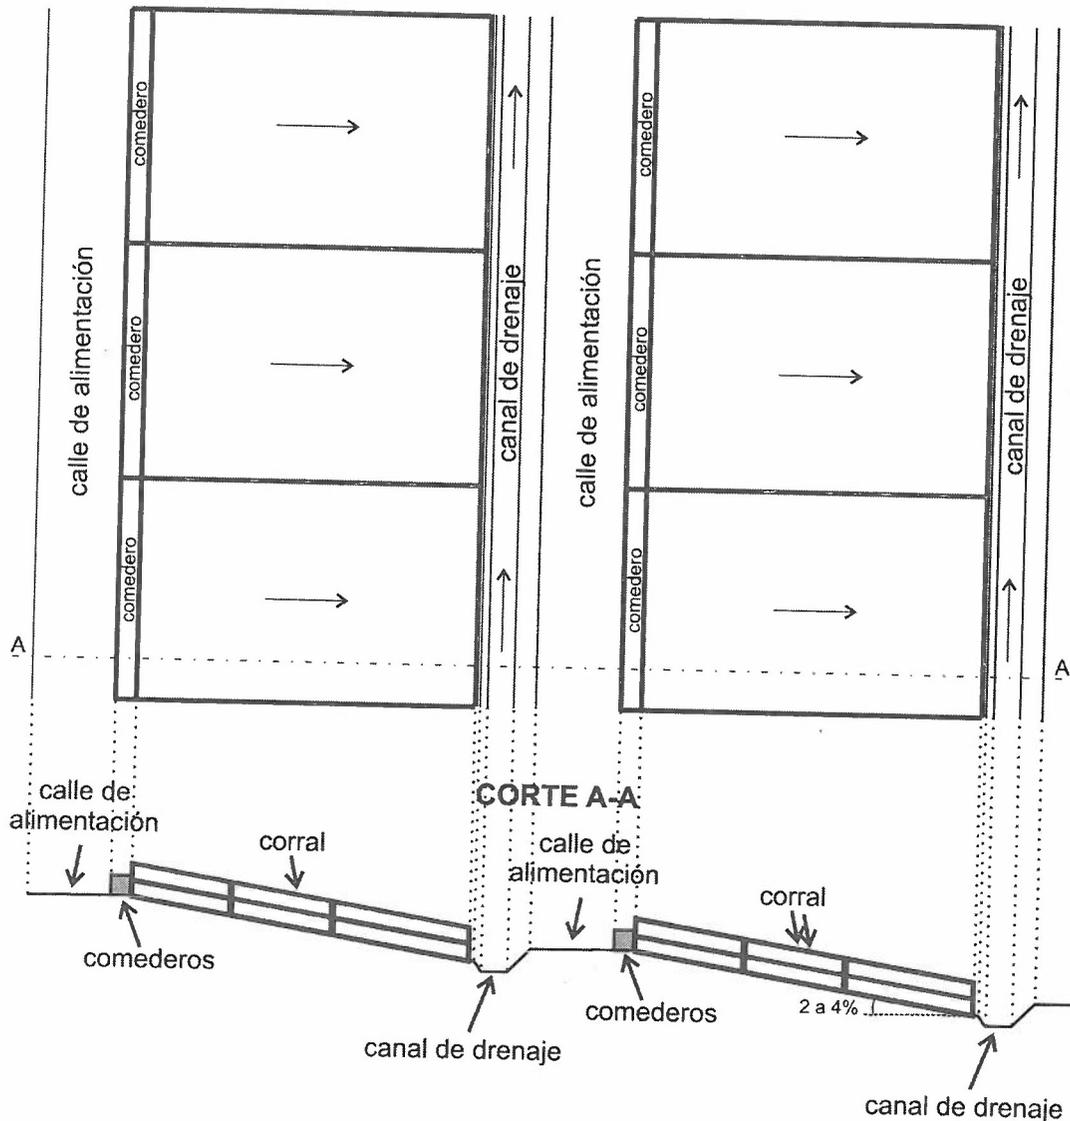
Esquema de Vista en Planta y Corte AA del escurrimiento superficial dentro de los Corrales y los Canales de Drenaje que lo reciben.
